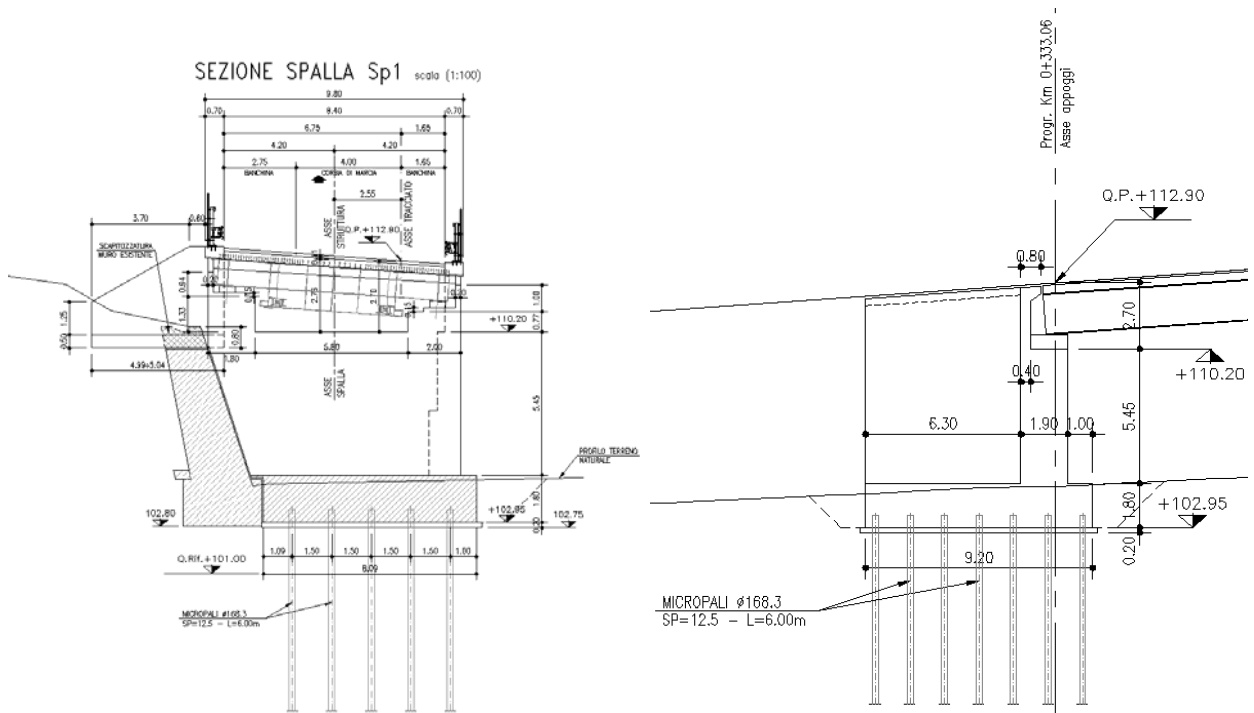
Sezioni della spalla 1 lato Livorno.
